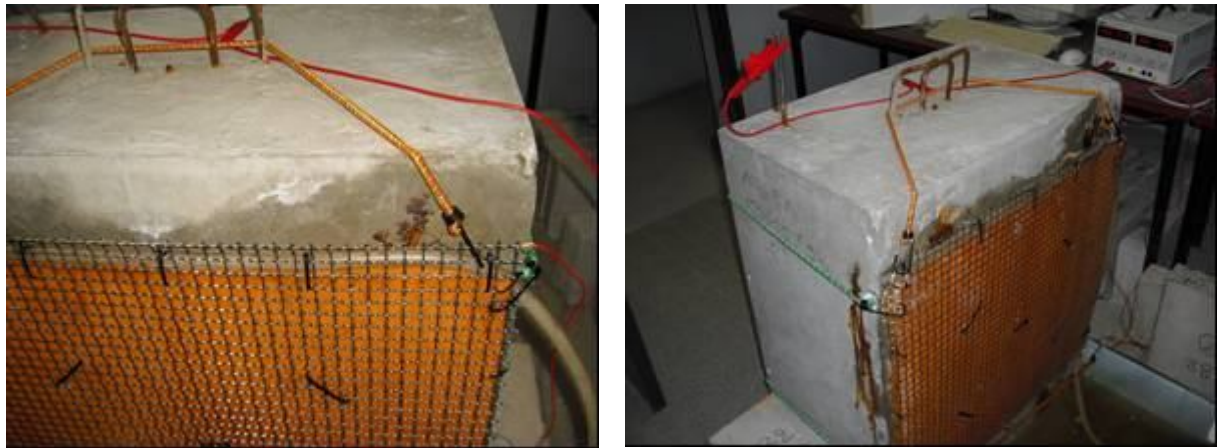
Fissuration sur la maquette (70 x 70 x 40 cm)
